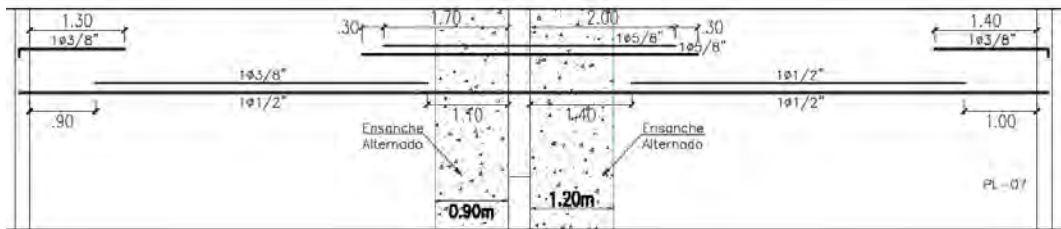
Disposición de acero en la losa aligerada del ejemplo.
